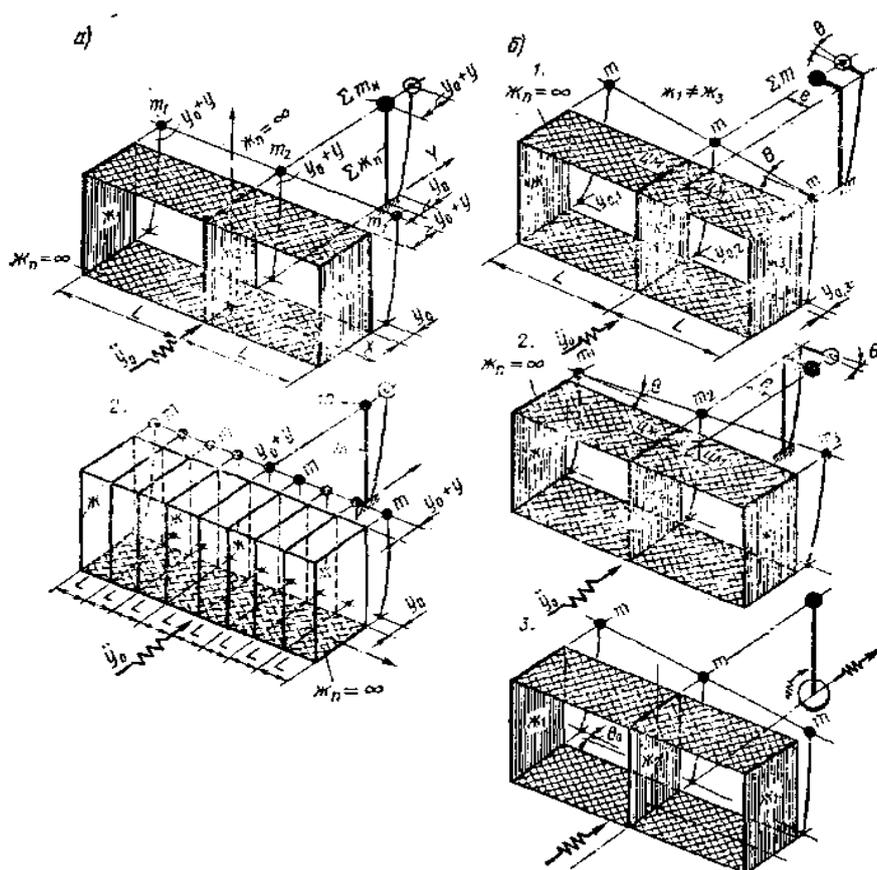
Схемы колебаний здания с абсолютно жестким перекрытием и его динамические модели.
